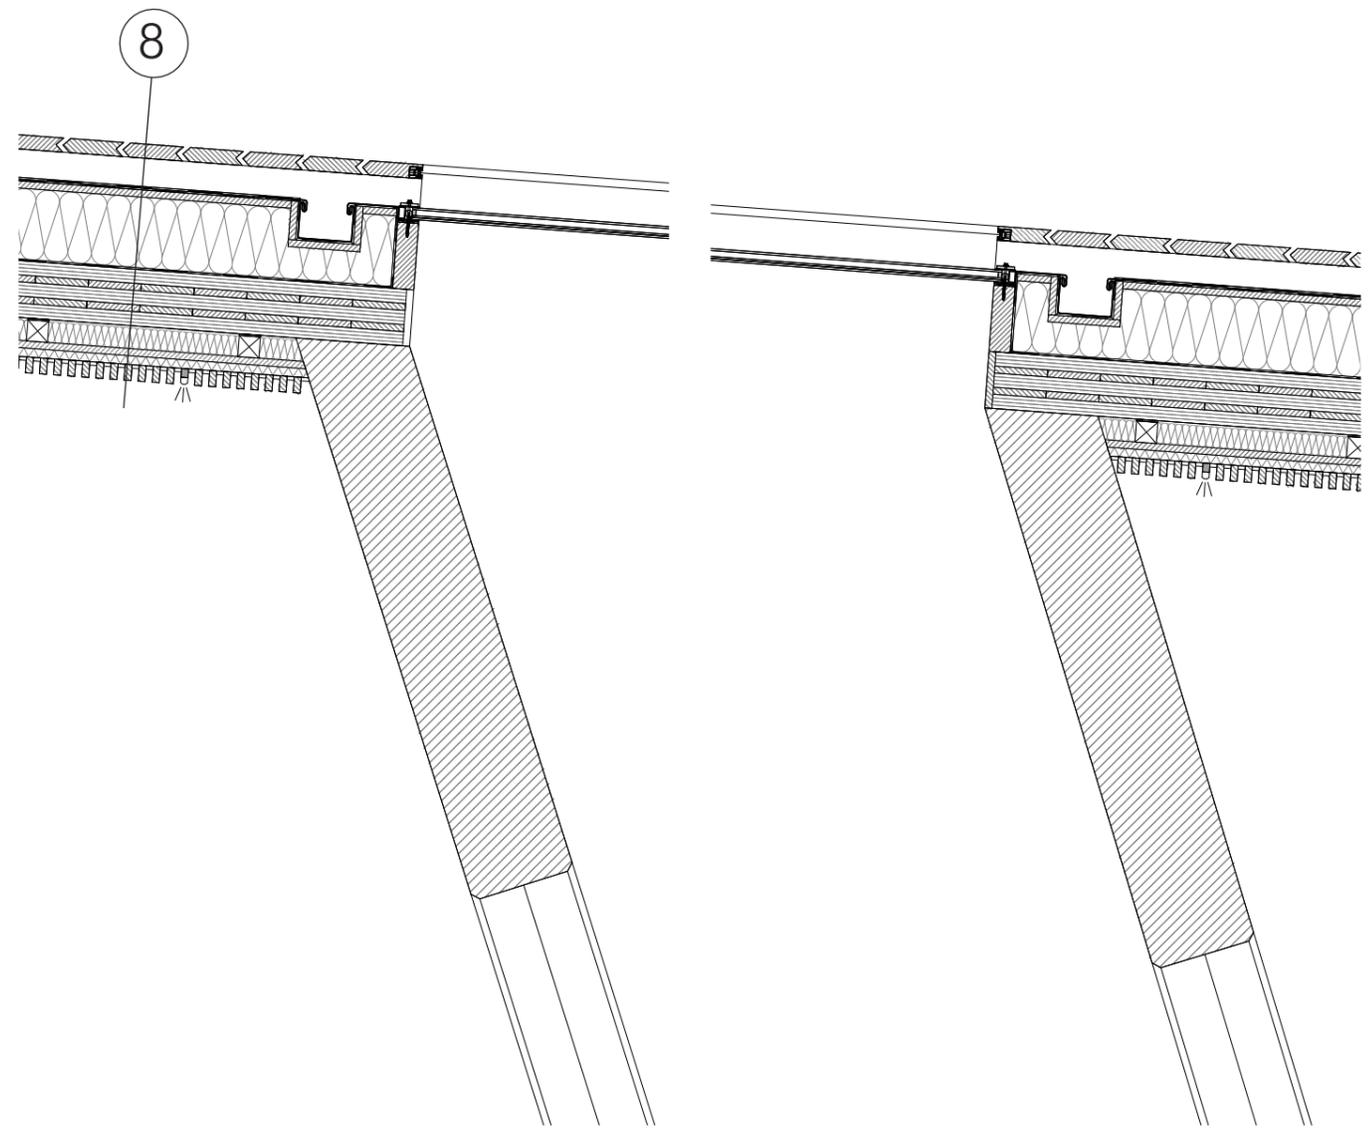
Fassadenschnitt 3 Fensterbanddetail 1:20
